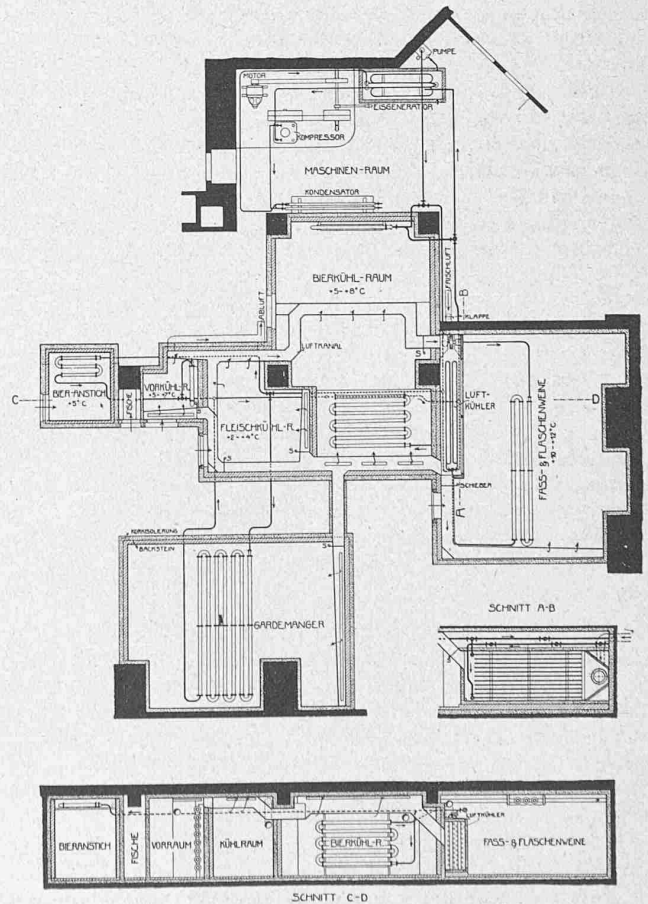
Kühlräume des Restaurants St. Annahof in Zürich. Grundriss und Schnitte. — Masstab 1:200.
